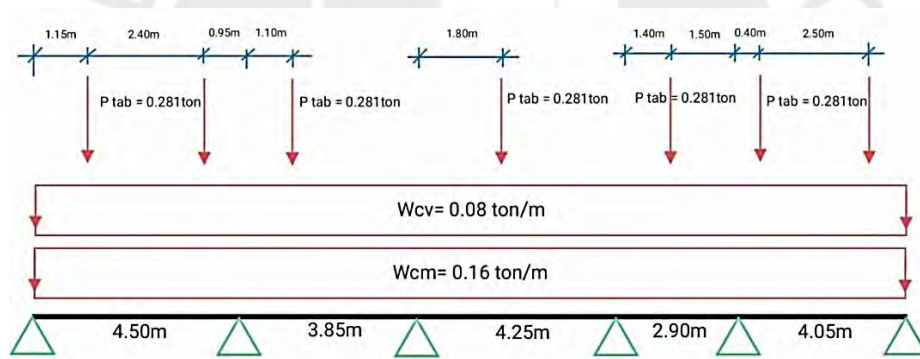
Esquema del metrado de cargas distribuidas y puntuales últimas sobre la vigüeta de losa aligerada
